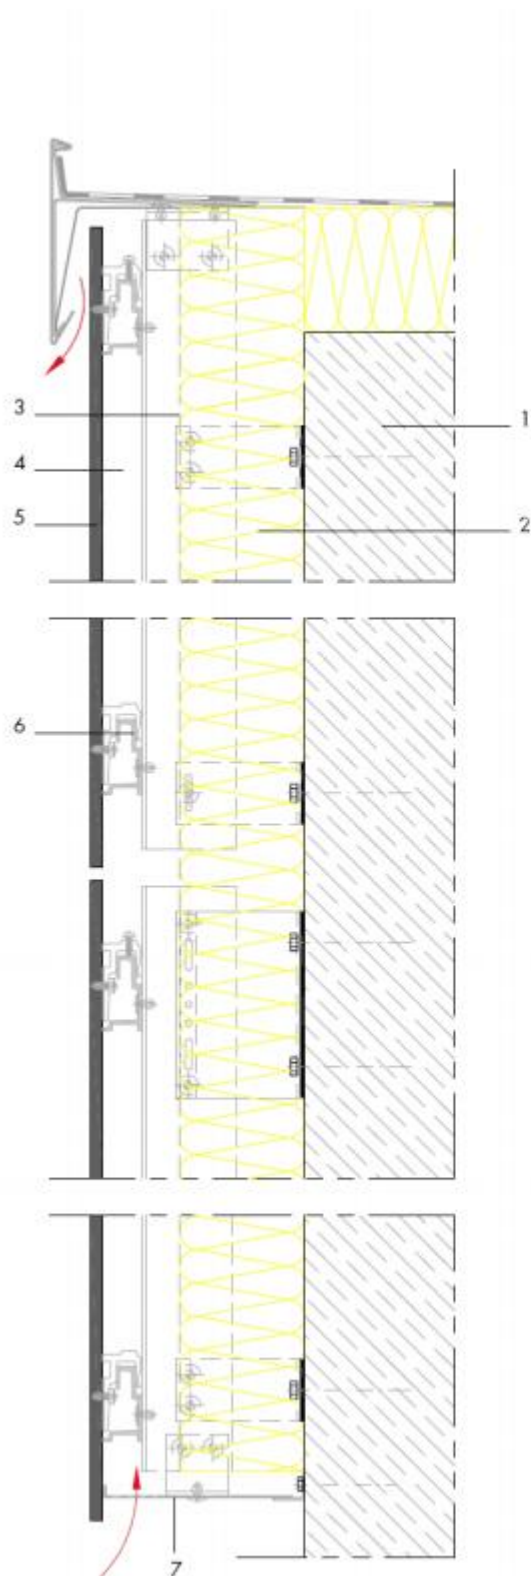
Coupe verticale d'une fixation invisible avec colliers de suspension
